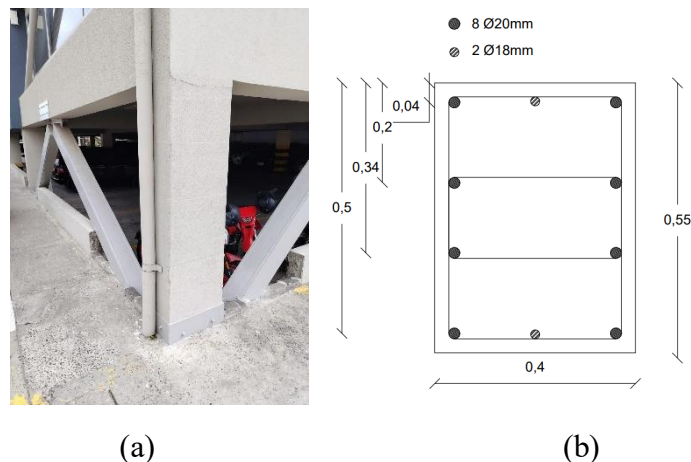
(a) Columna confinada en el eje A6. (b) Sección transversal de la columna
